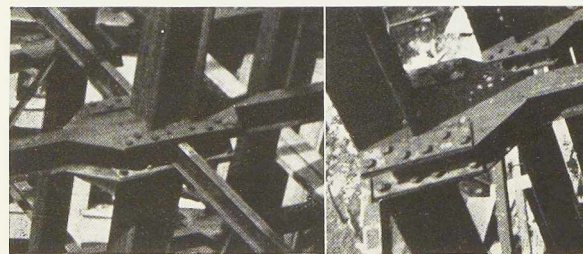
Détails des assemblages à goussets horizontaux : assemblage intermédiaire, assemblage d'extrémité.
